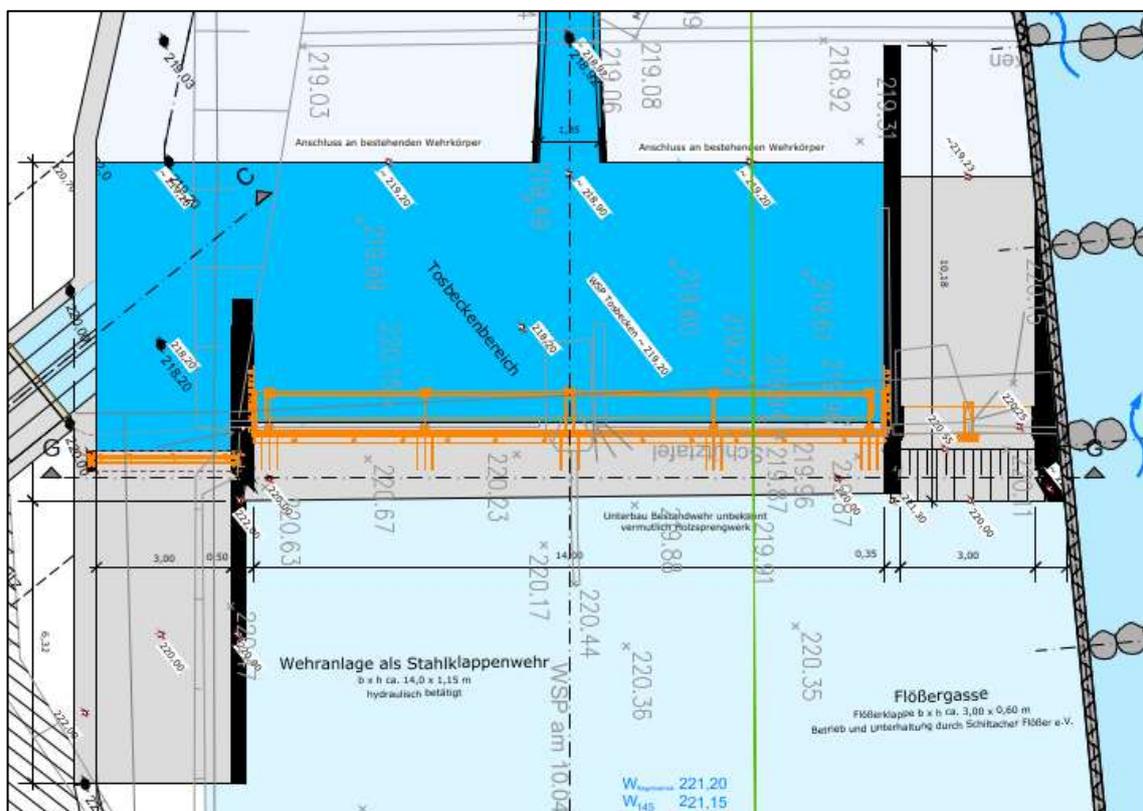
geplante Wehranlage mit Flößergasse und Entlastungsschütz (Draufsicht)
